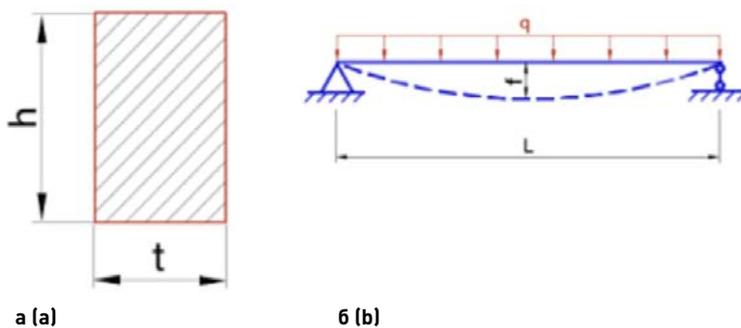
Схема сечения (а) и нагружения балки (б) при расчетах
